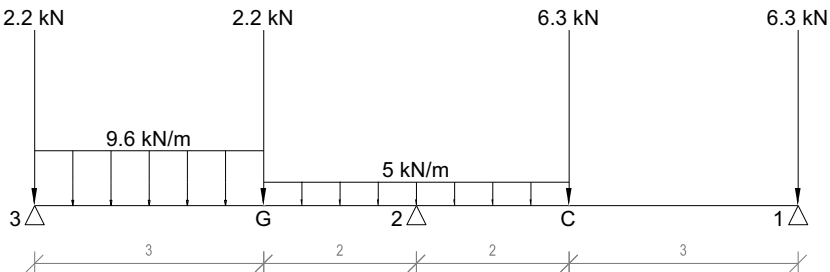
Sobrecarga de uso en el pórtico 1-2-3 de la planta 1ª.
